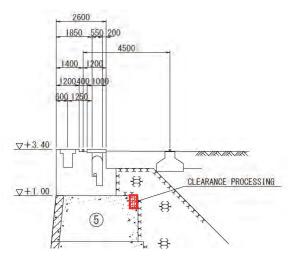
Preenchimento das Frestas dos Blocos por Gravidade do Muro (Lado da Terra)
